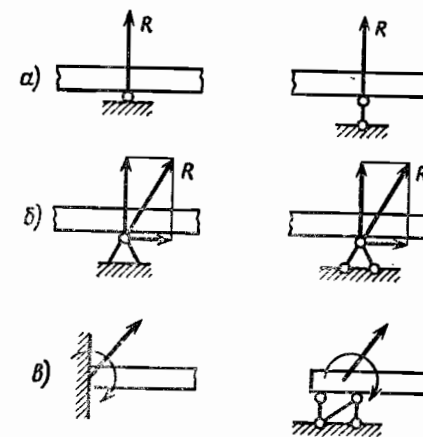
Опорные закрепления стержня: а — шарнирная подвижная опора; б — шарнирная неподвижная опора; в — заделка
